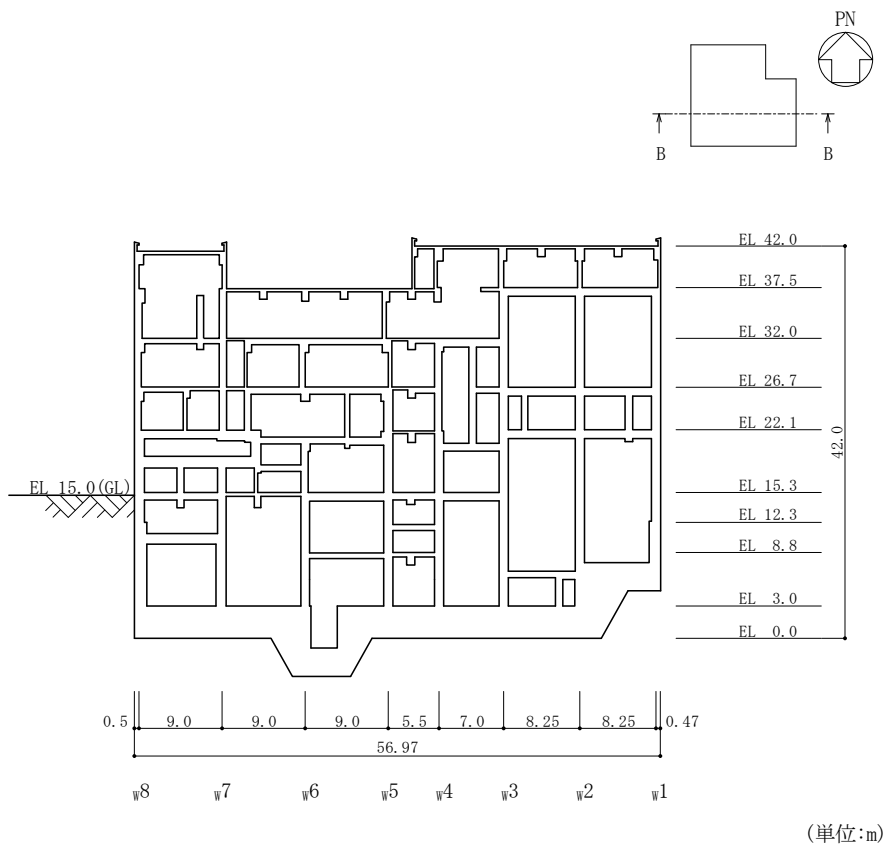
(2) 廃棄物処理建物の概略断面図 (B-B 断面, EW 方向)
